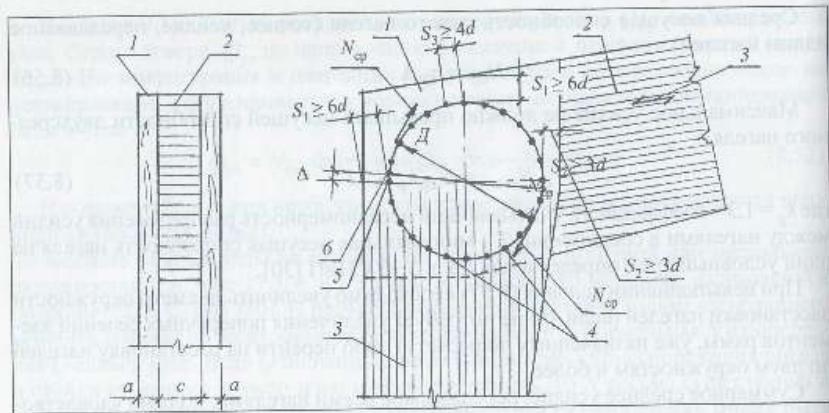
Расчетная схема узла жесткого соединения ригеля со стойкой на цилиндрических настиках:
